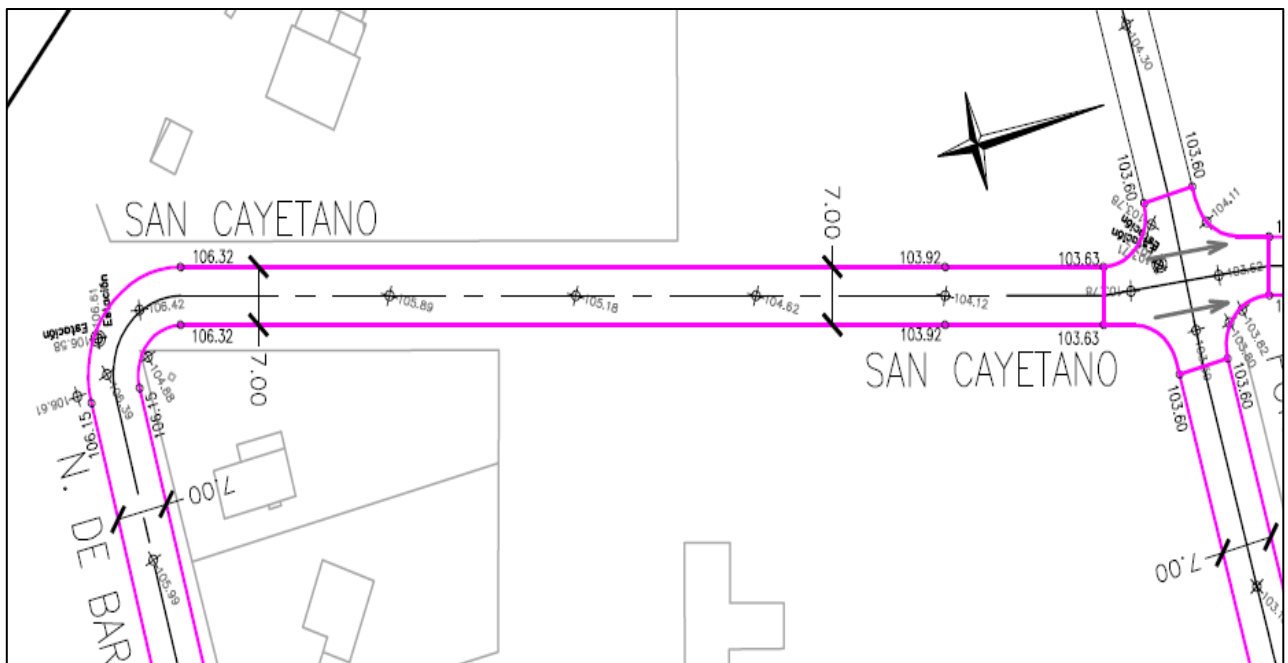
Planimetría de tramo de calle San Cayetano e/ Nicolas de Bari y Punta del Este. –
